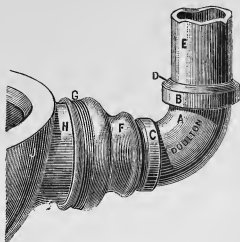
Ensemble des ligatures du tuyau du réservoir de chasse E D à la douille H de la cuvette.
